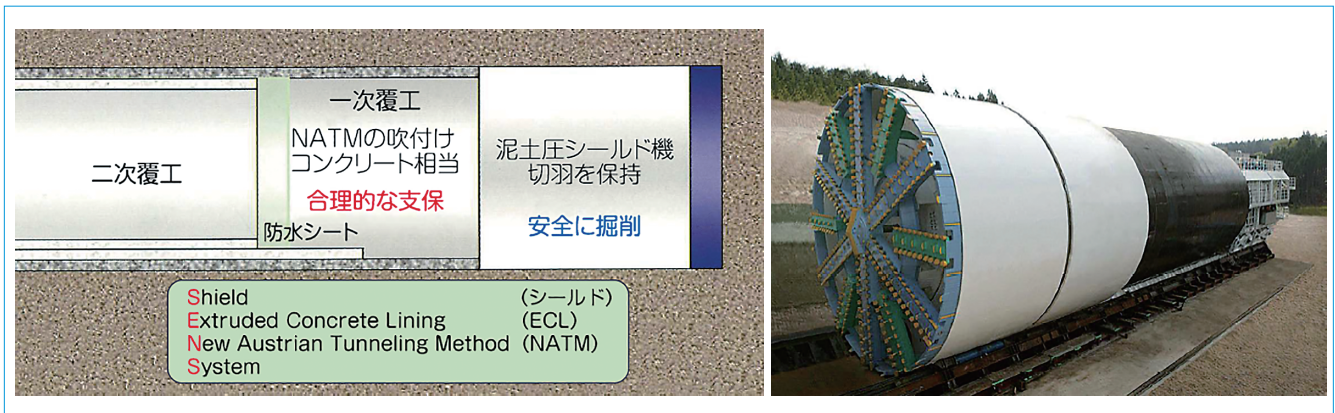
SENS工法 (Shield Extruded Concrete Lining New Austrian Tunneling Method System)⁸⁾
